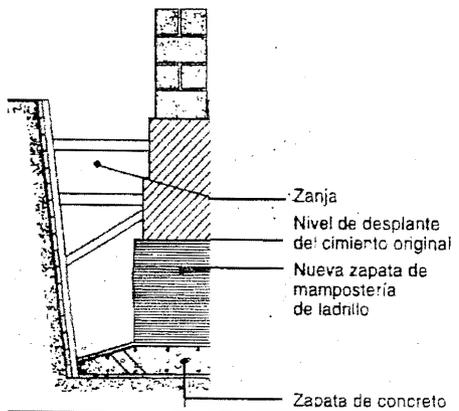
Recimentación consistente en ampliar la profundidad de los cimientos, hasta alcanzar estratos del terreno más estables.
